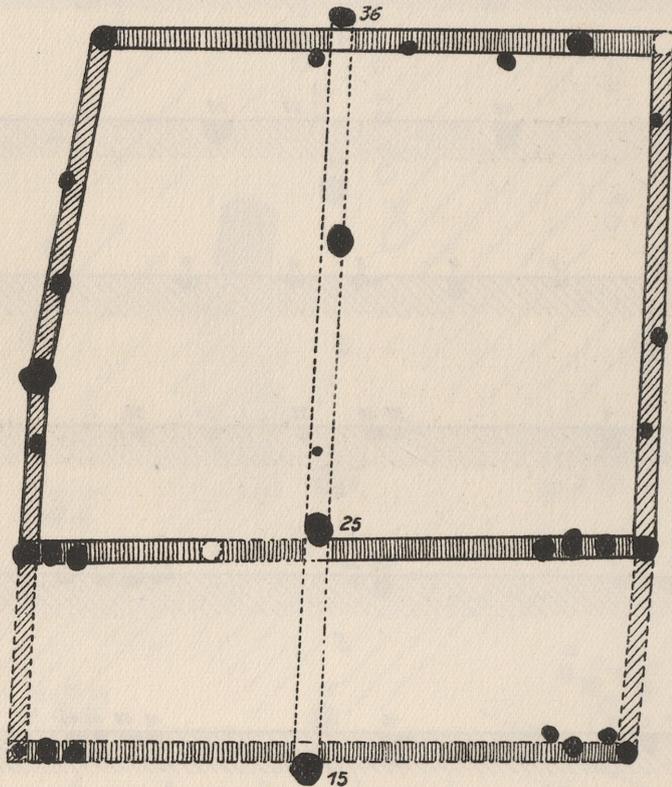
Rekonstruktionsgrundriß des Hauses von Bruckhausen.
